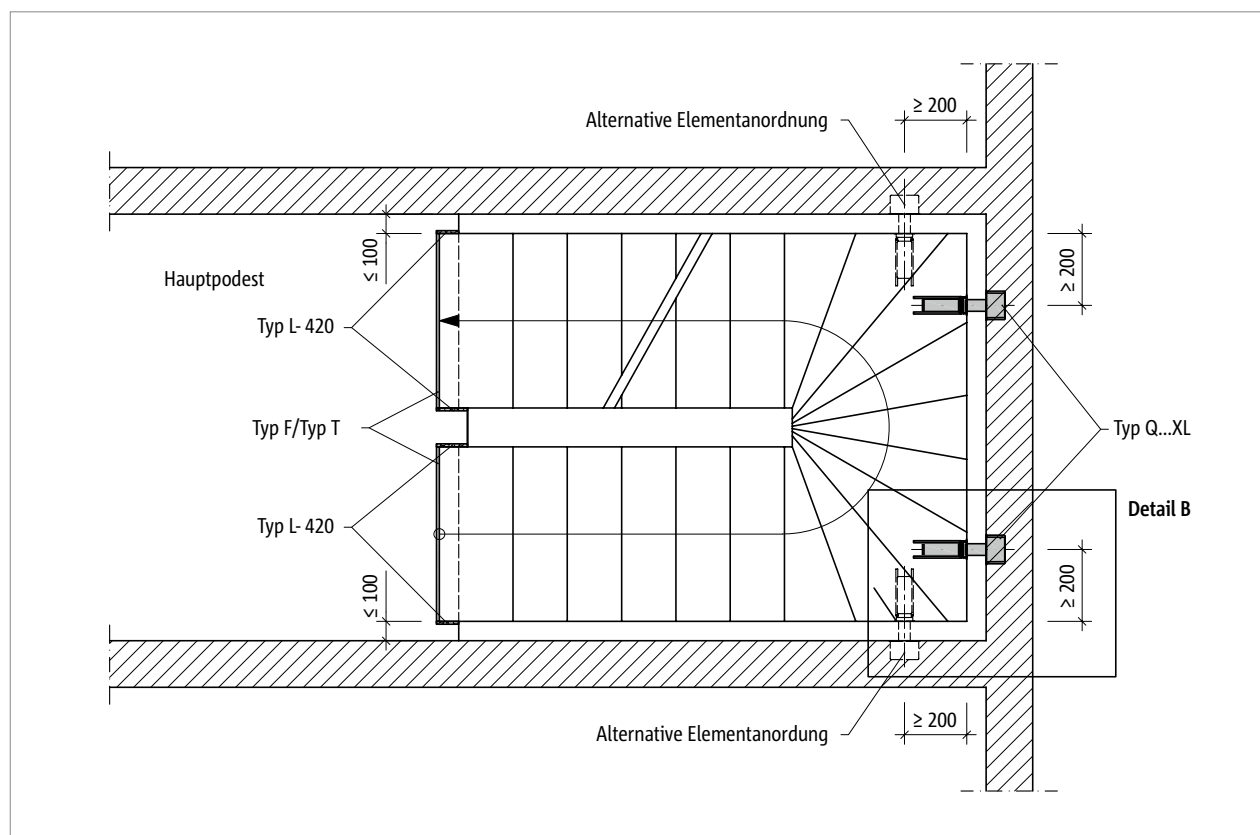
Tronsole® Q...-XL: Elementanordnung im Grundriss bei einer Fugenbreite von maximal 100 mm
